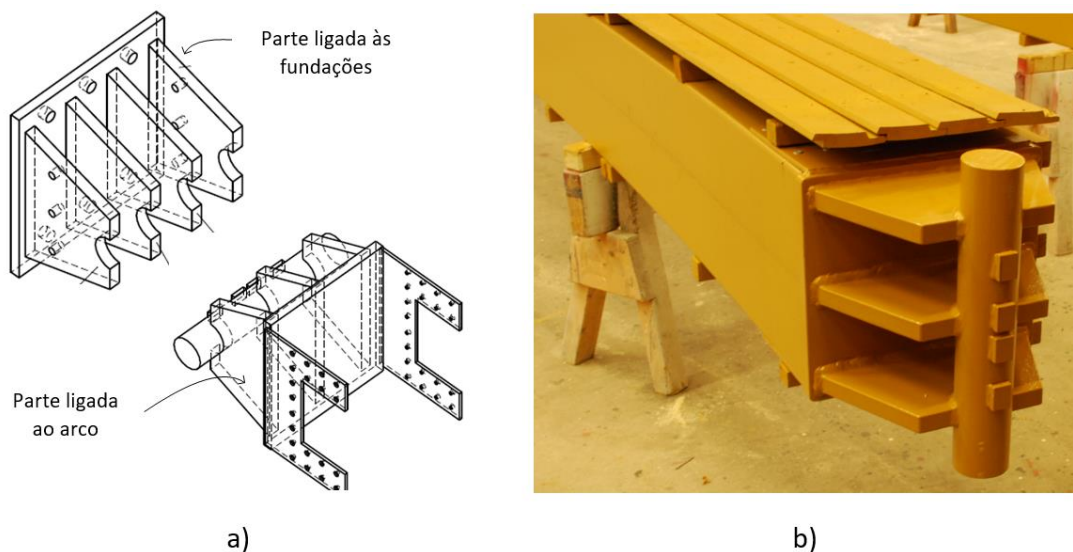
Pormenorização das rótulas nos apoios em a) Projeto e b) Executado.
